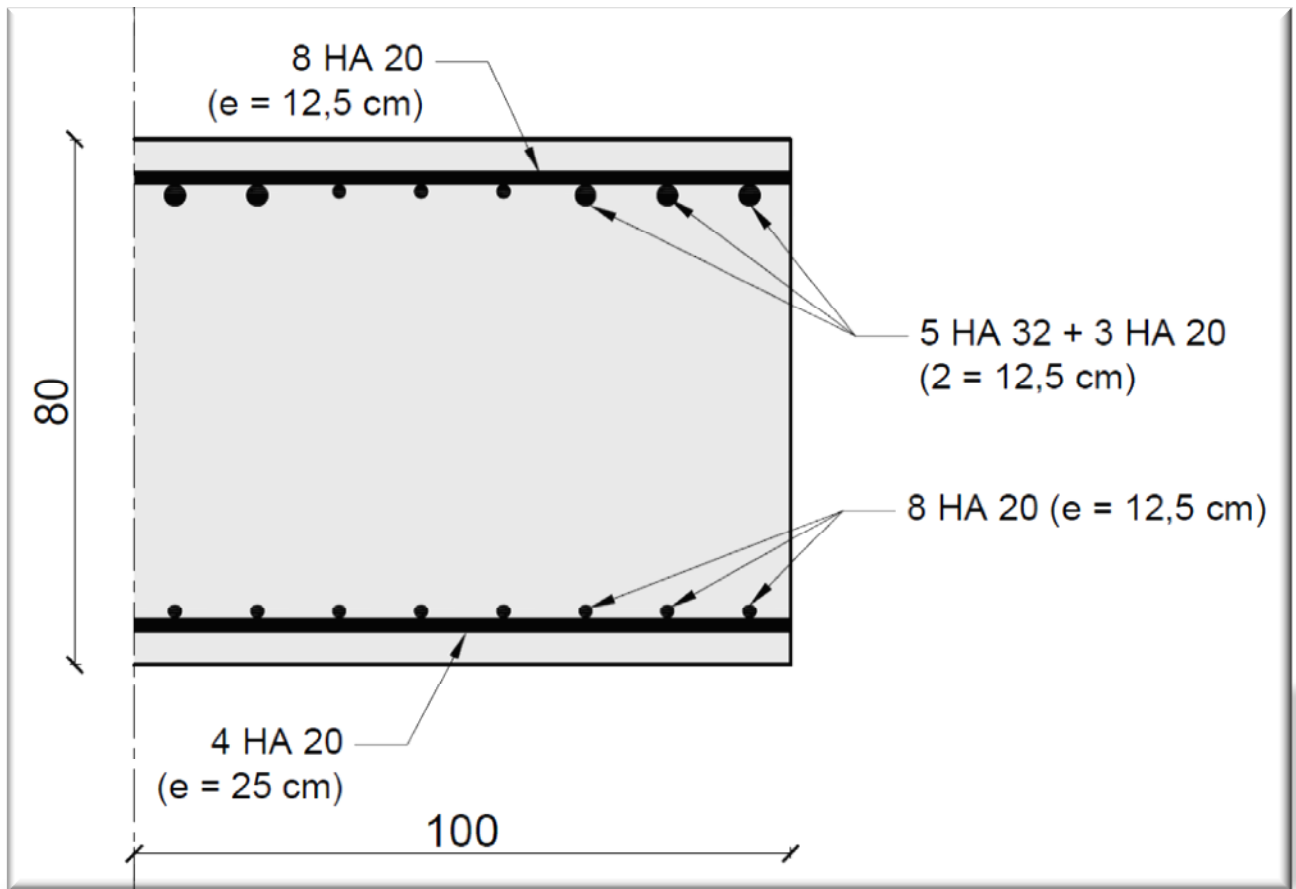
Schéma de ferraillage de la dalle.
